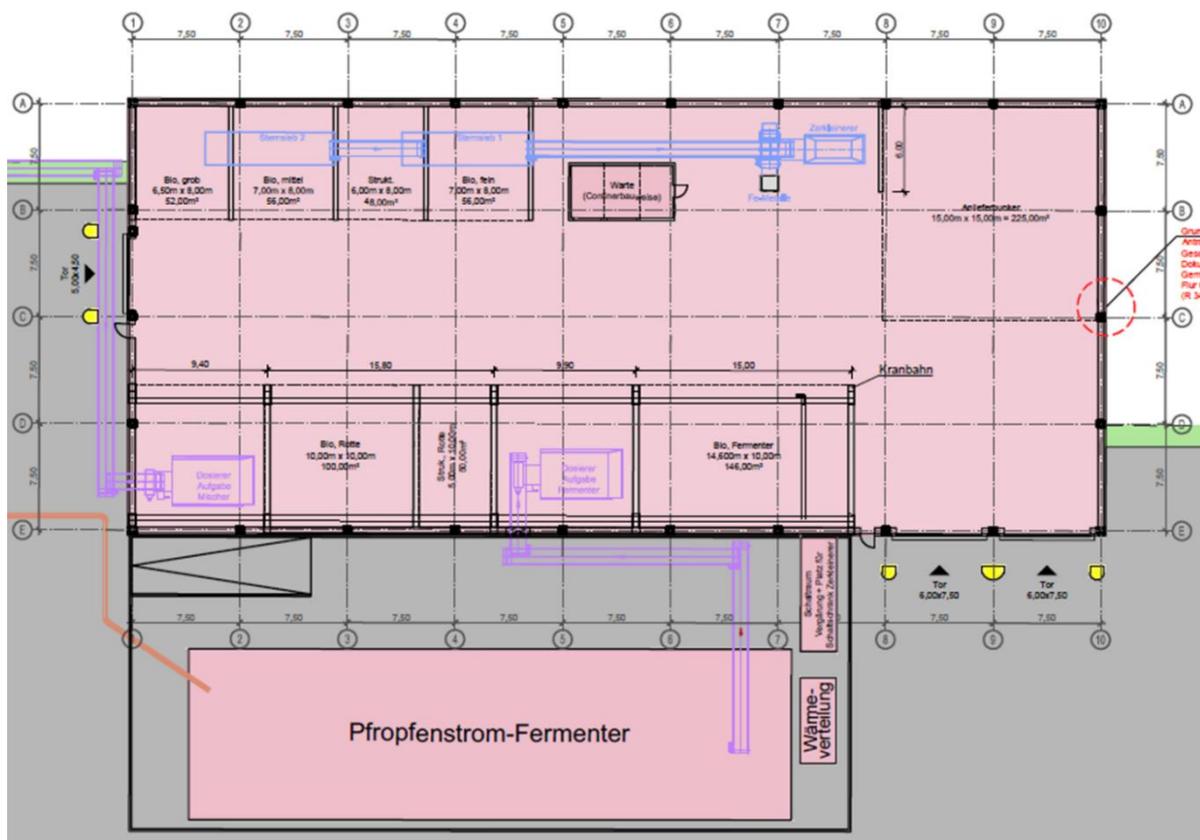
Planausschnitt Lageplan Standortlayout V2
